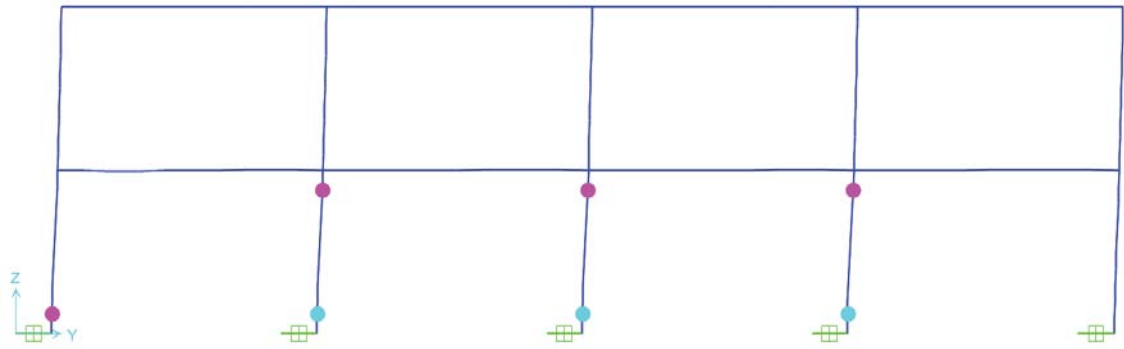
Secciones de columna en estado de Resguardo de la Vida – Aislado
